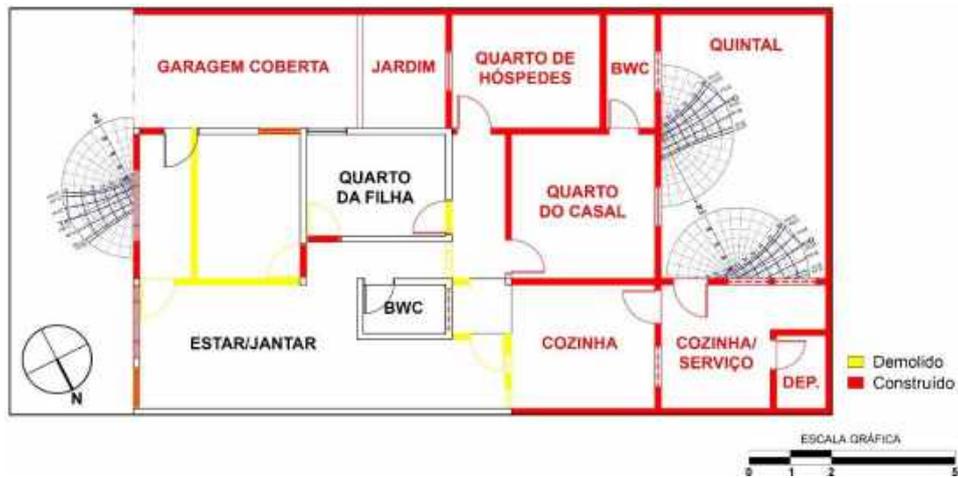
Planta baixa de reforma da residência 5, com indicação da insolação nas fachadas.
